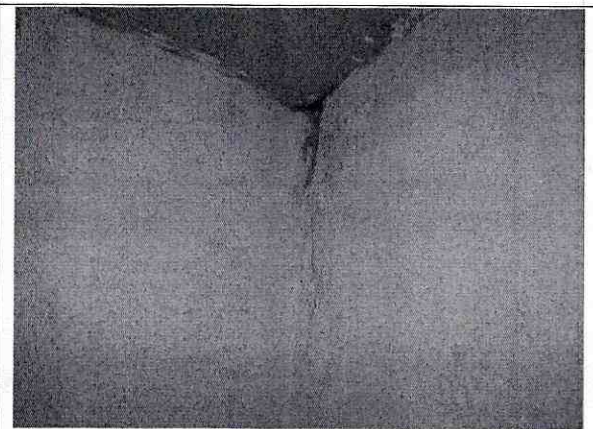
Fisuras del muro de fachada, vista interna.
